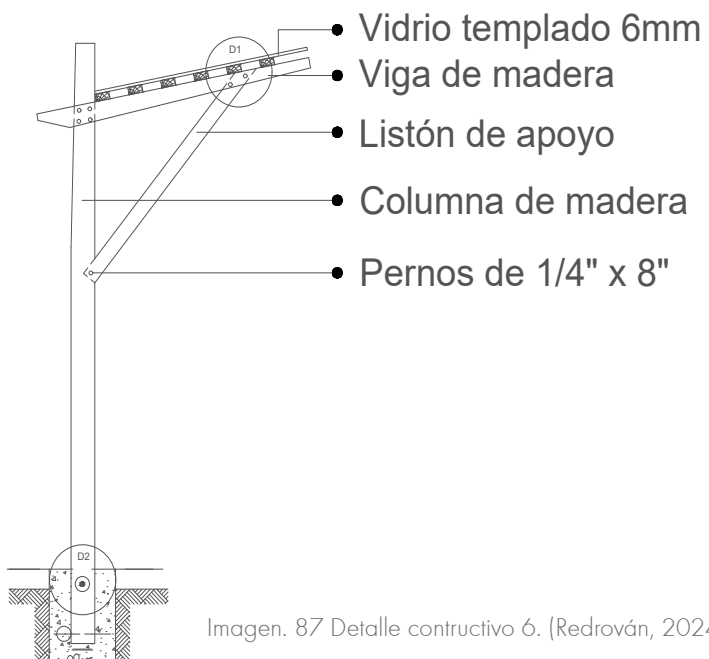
Detalle constructivo 6. (Redrován, 2024).
